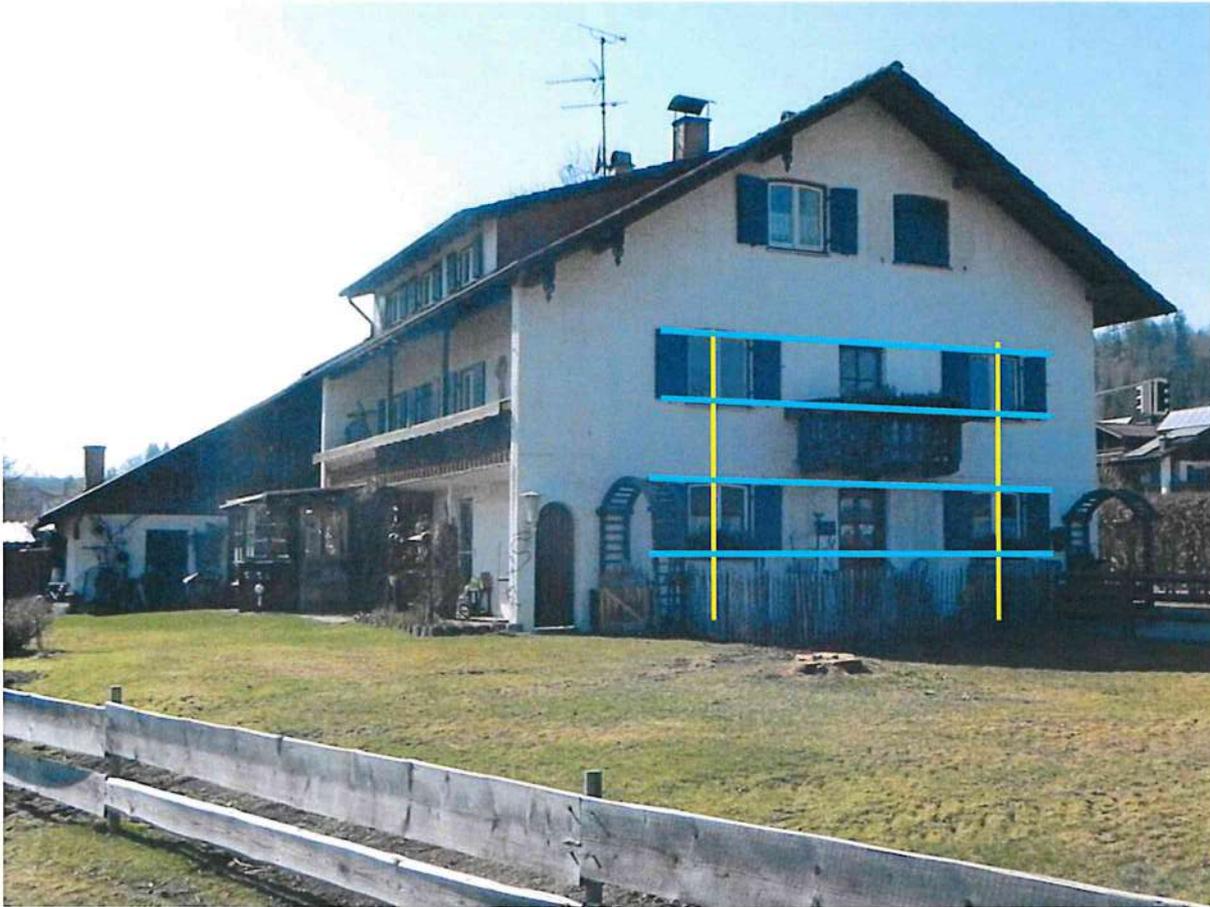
Verputzte Ostfassade des Bestandes mit im Erdgeschoss und Obergeschoss übereinander liegenden Fenstern und Fenstern (gelbe Linie) und in überwiegend gleicher Höhe je Geschoss (blau)
